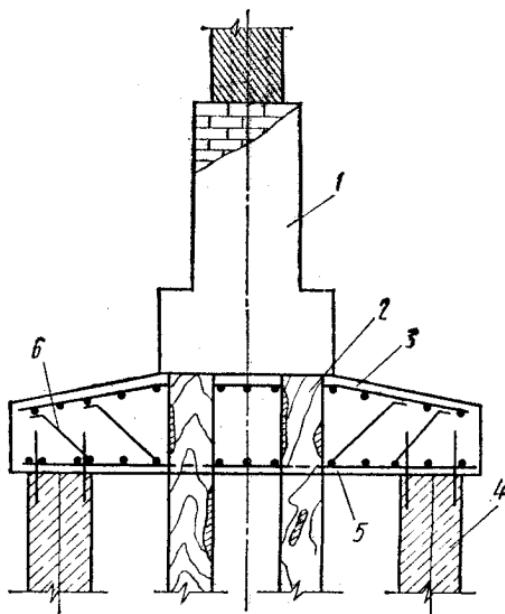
Усиление ленточного фундамента сваями с подводкой нового ростверка:
